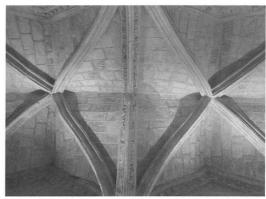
Bóvedas con plementería de piedra (foto del autor 2012)
